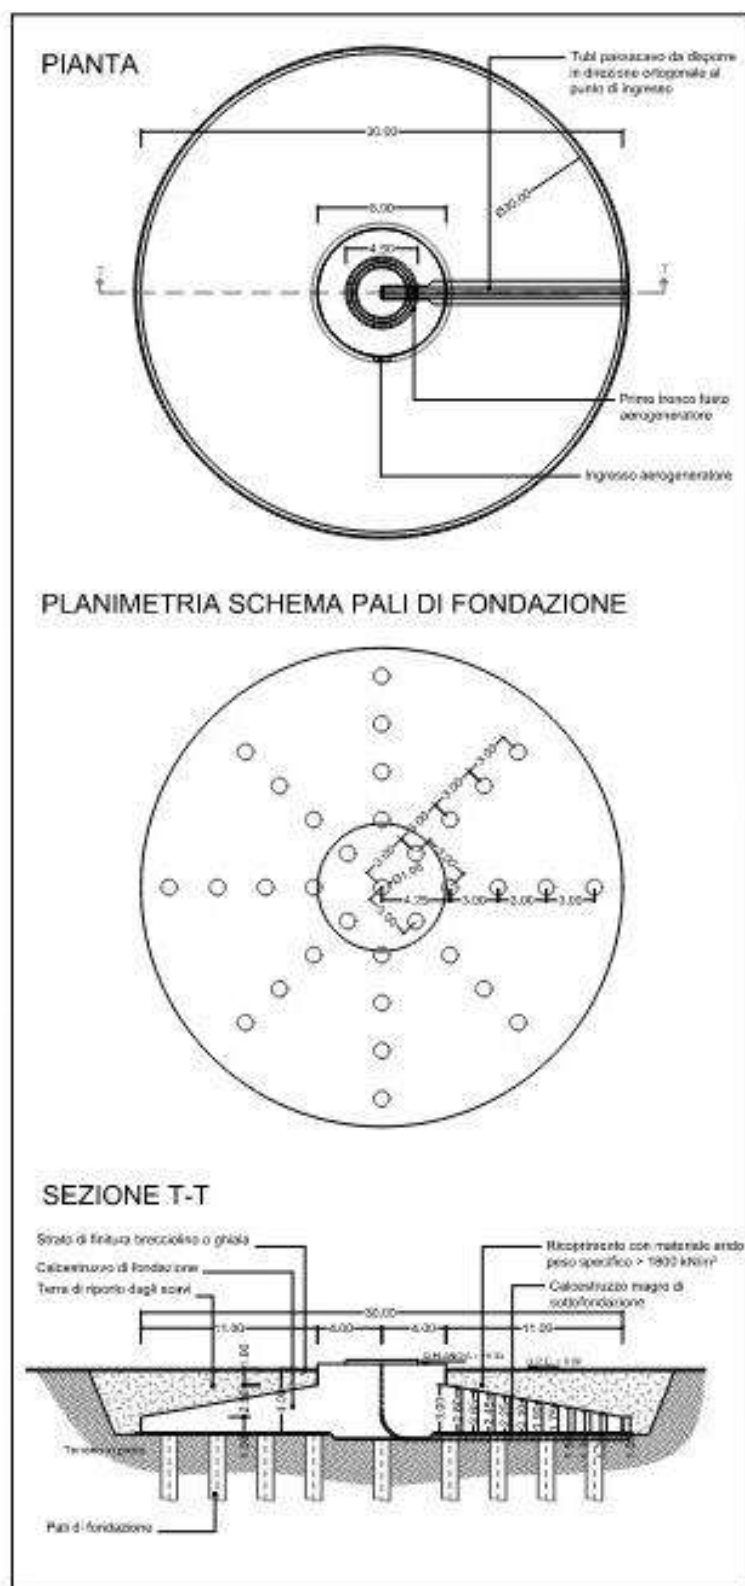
Pianta e vista della fondazione tipo dell'aerogeneratore in caso di fondazione indiretta
